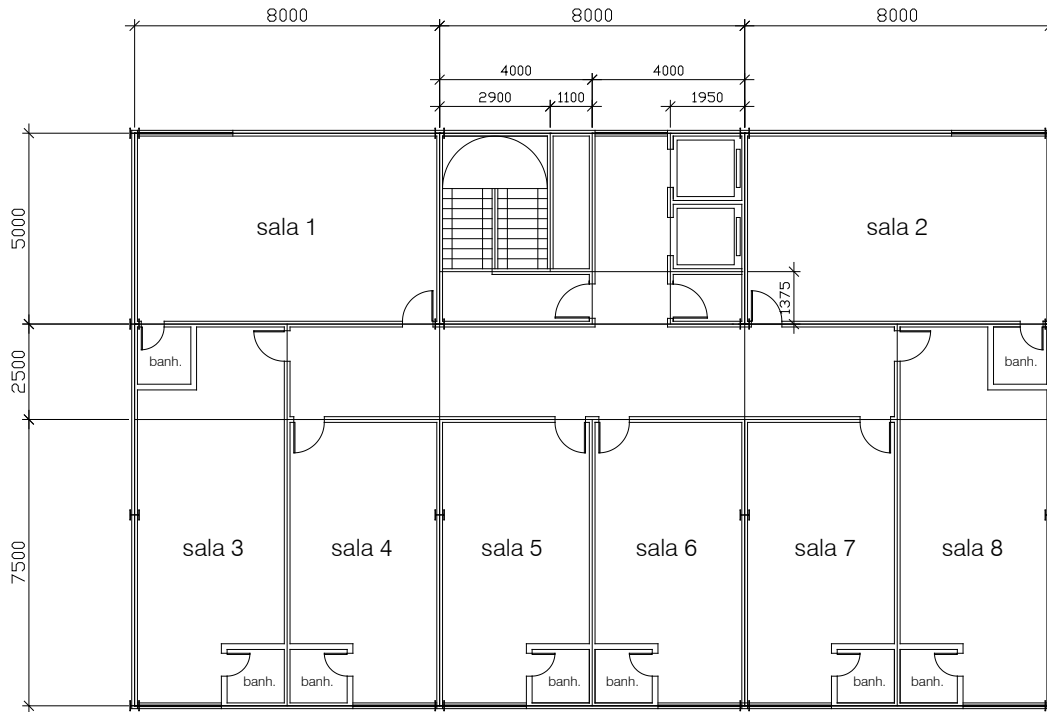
Planta Baixa do pavimento tipo – cotas em mm [3].
